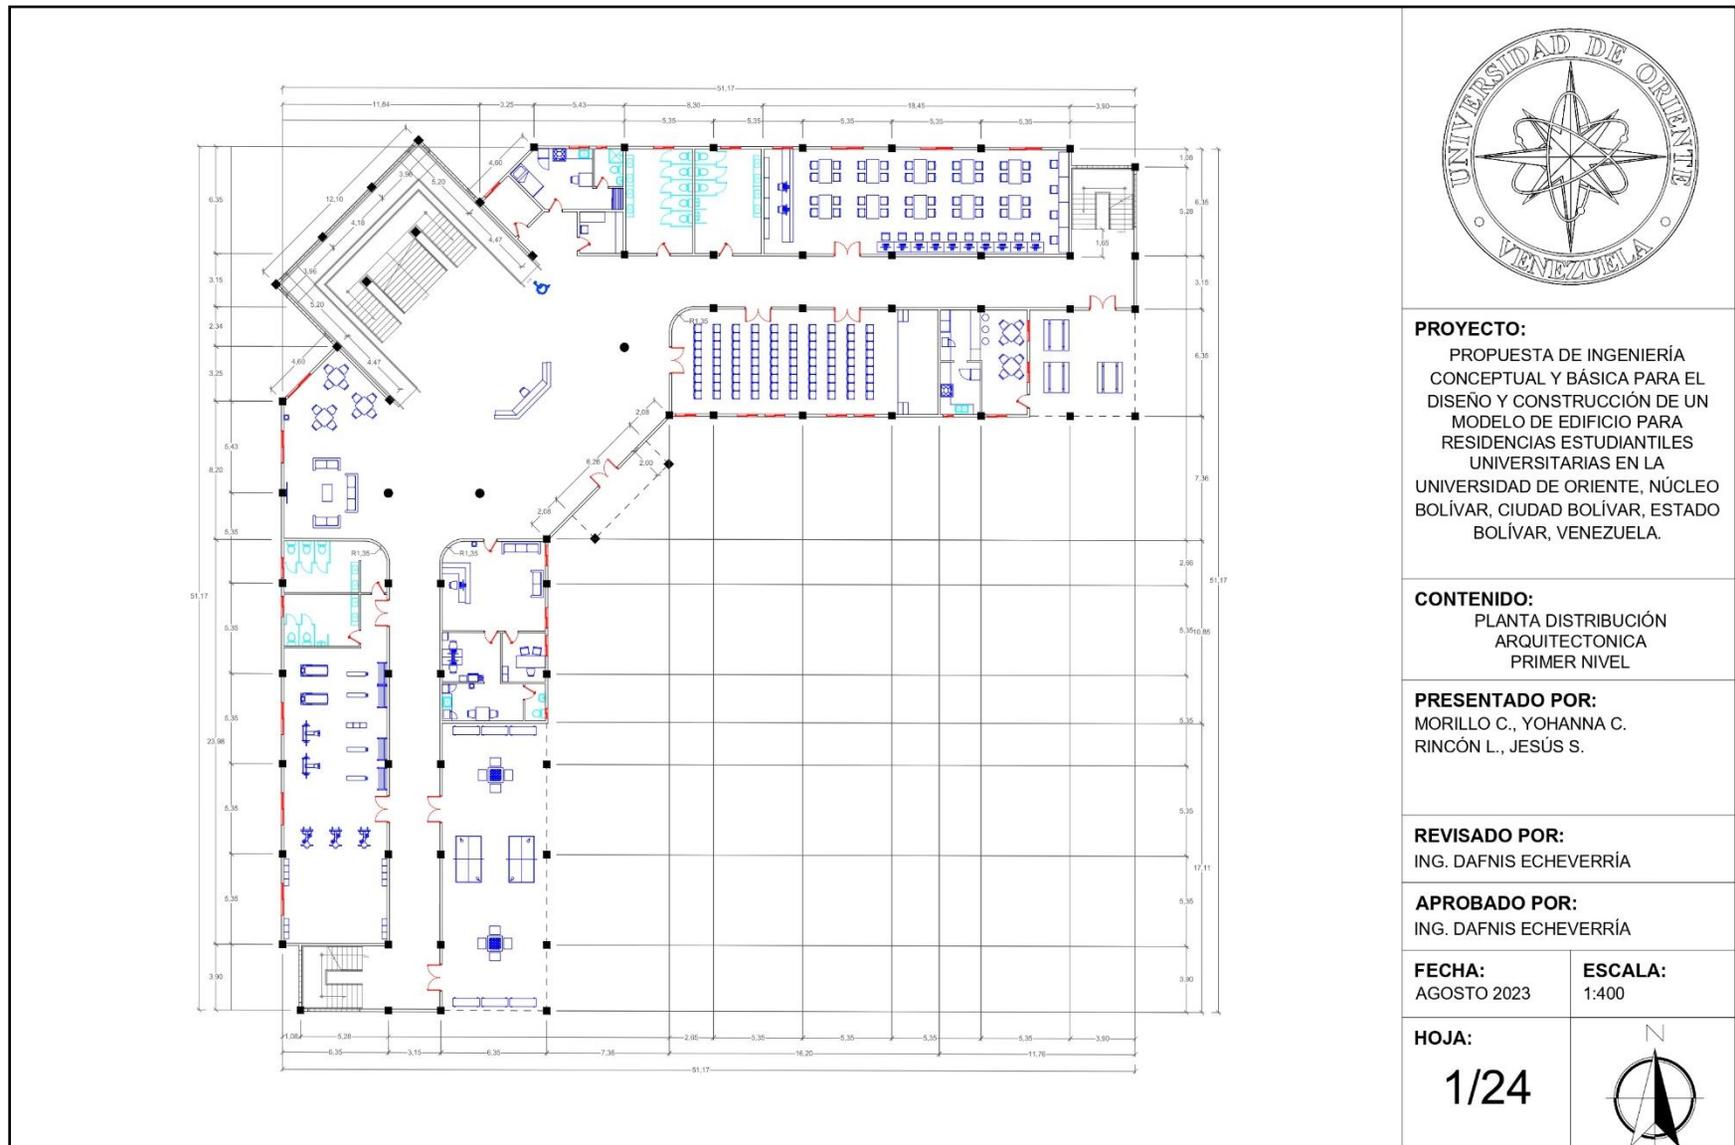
Plano de Planta distribución arquitectónica. Primer nivel.
